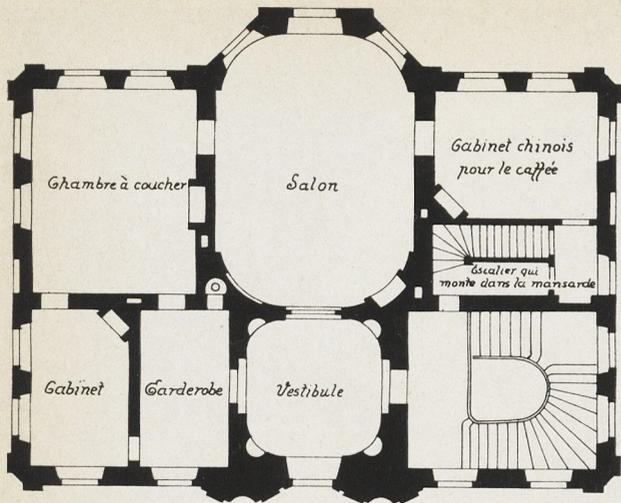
Jagdschloß Falkenlust. Grundrisse Schloß (nach Cuvilliers)
